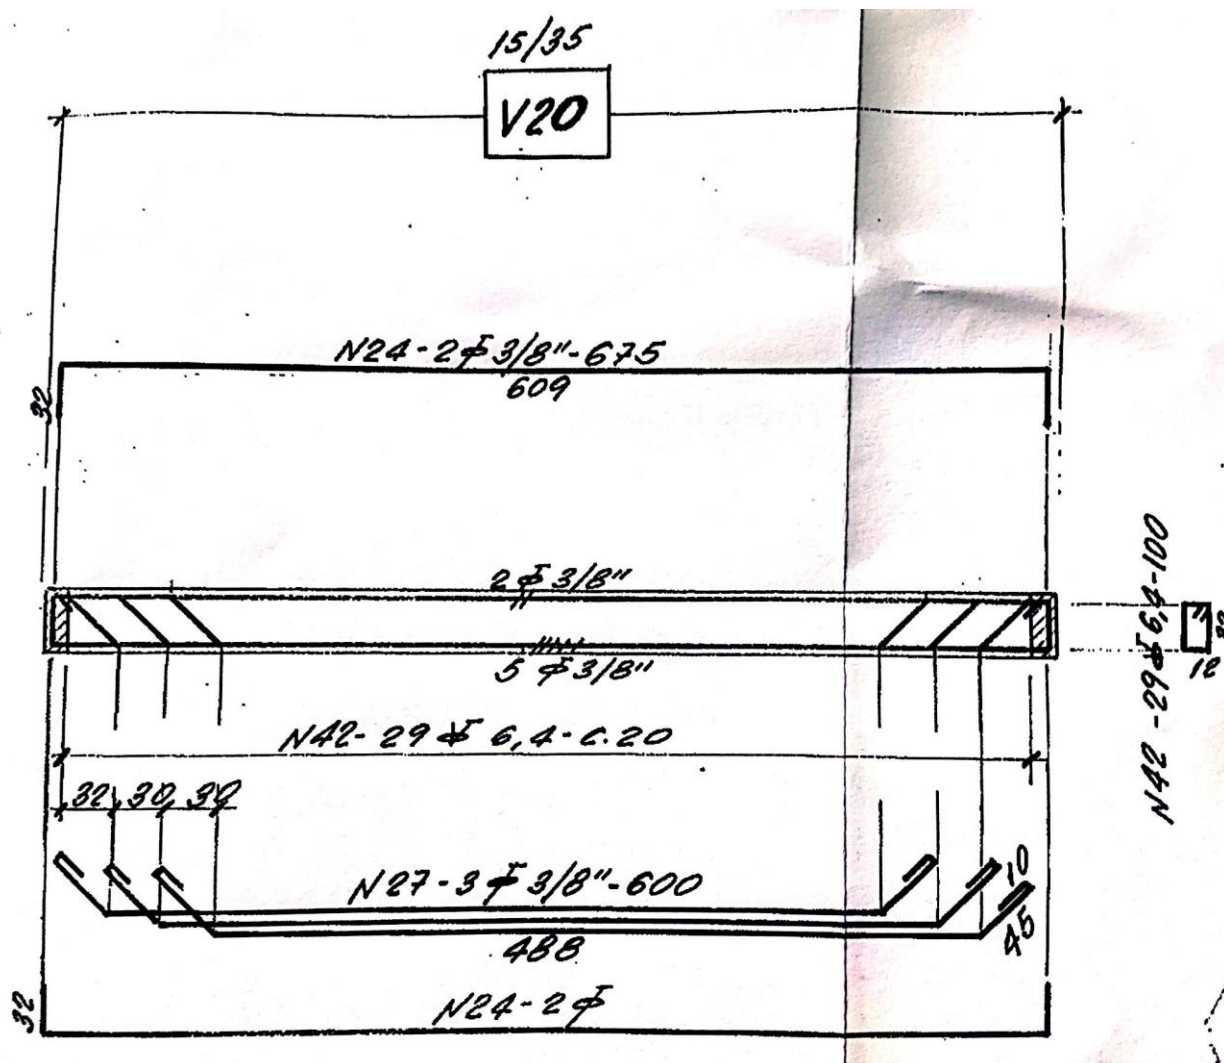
Det. de Armação da Viga da Cobertura - V20
